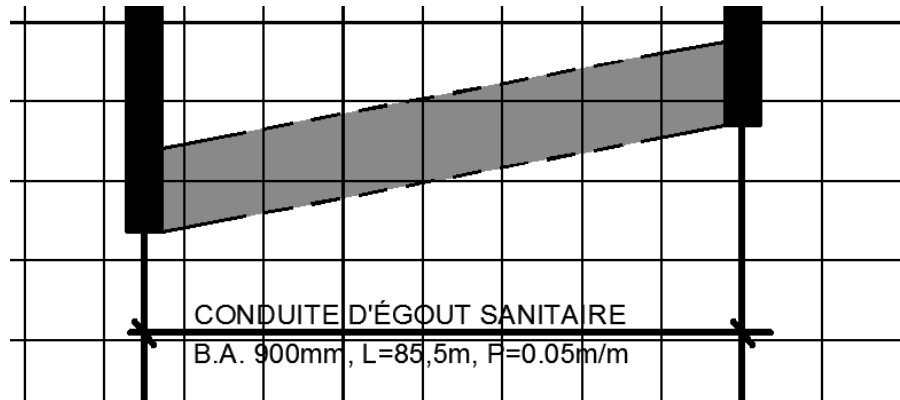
Exemple d'identification de section de conduite sur profil
